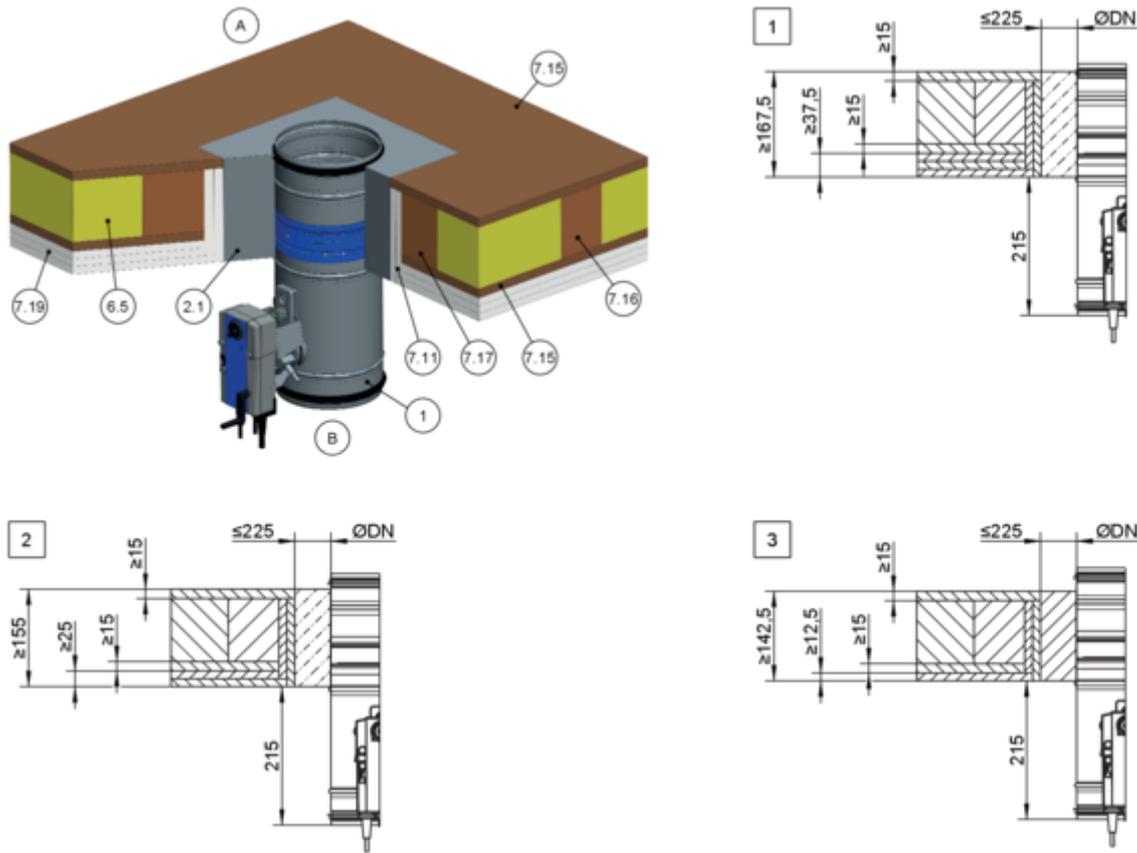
Nasseinbau in Holzbalken-/Leimbinderdecke, stehend (Abbildung stellvertretend, alternativer Deckenaufbau auf Anfrage möglich)
